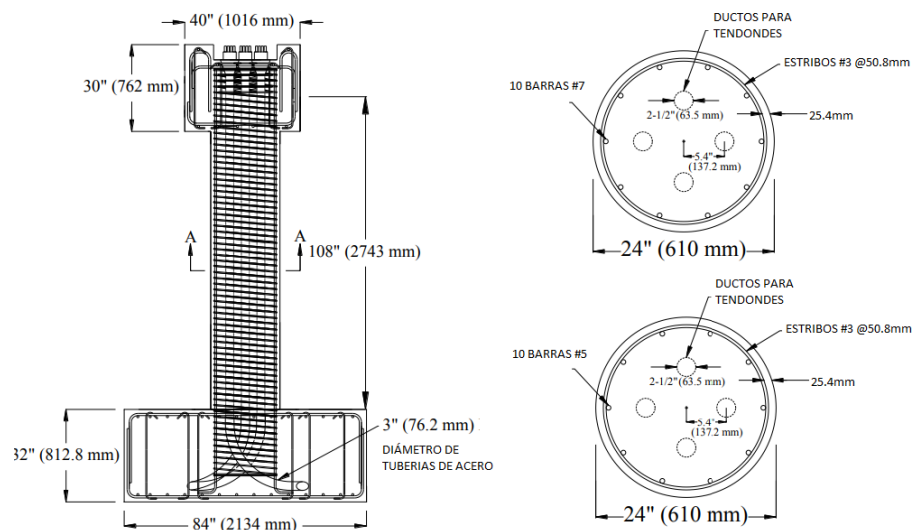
Secciones de las columnas ensayadas en la universidad de Reno nevada (26)
